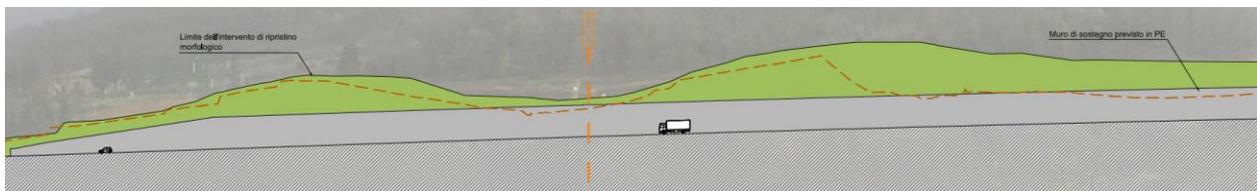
Prospetto nuova carreggiata sud del progetto autorizzato: muro di sostegno alto 7 m
